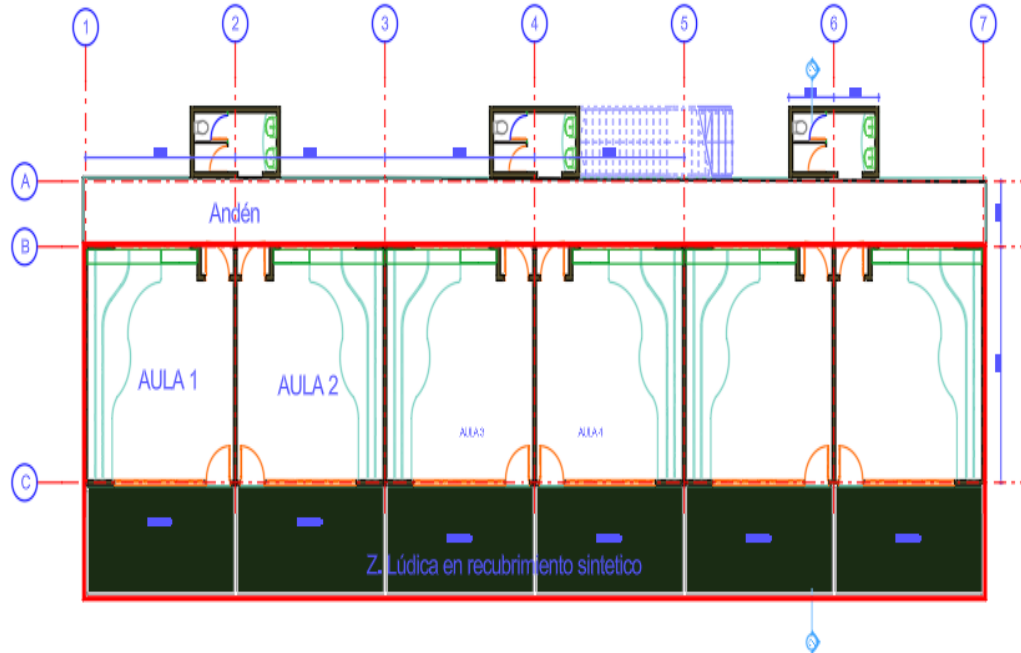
Referencia Arquitectónica Aula primera infancia o preescolar con batería sanitaria, proyección del área de la placa de cimentación de aulas y zona juegos de la fachada posterior.
